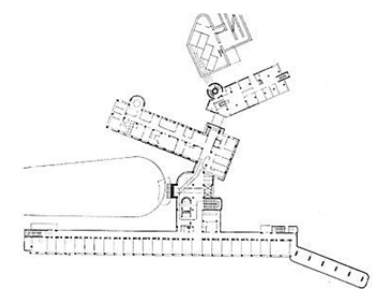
Planta do piso de entrada do Sanatório de Paimio, Alvar Aalto. (1932)
